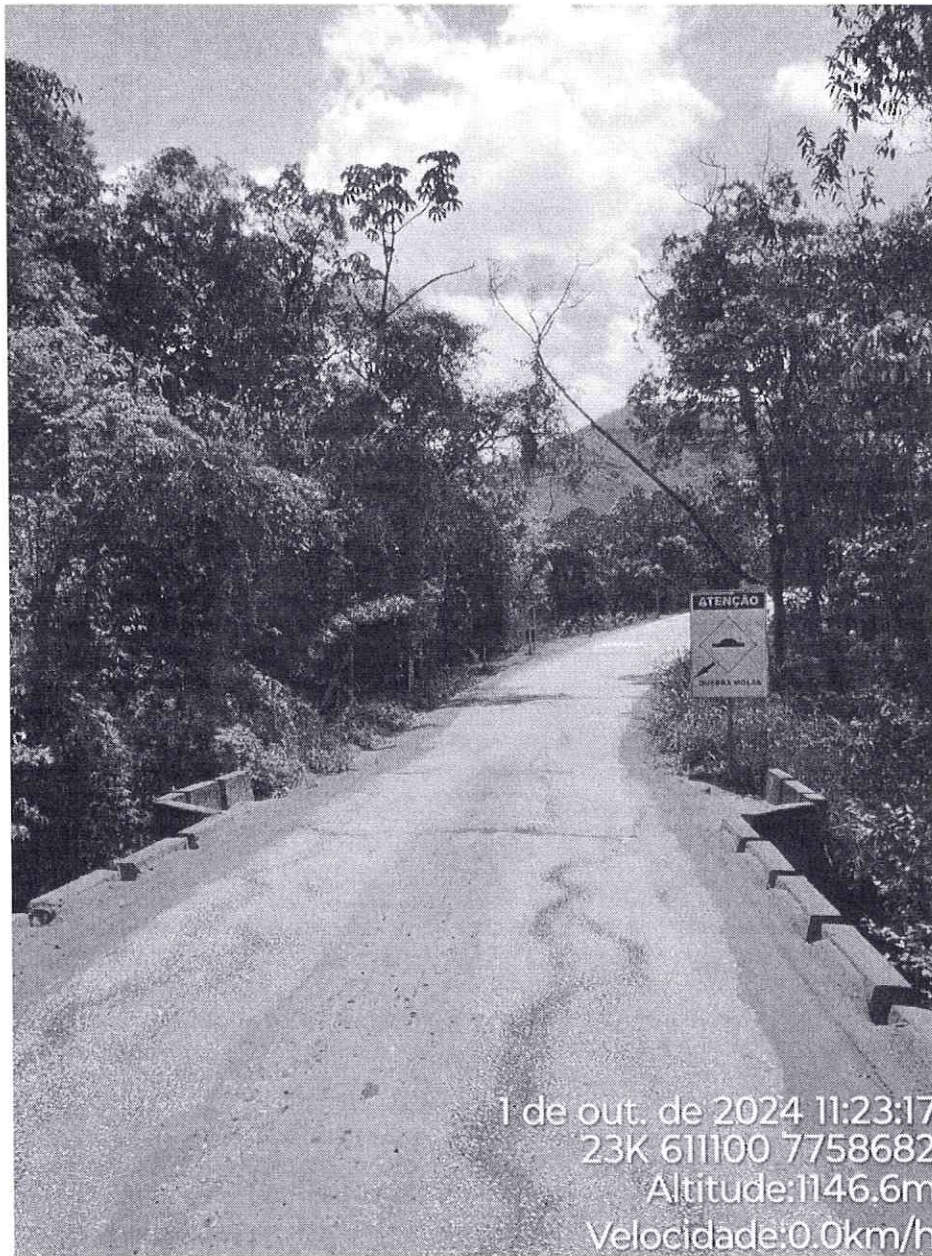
Vista da ponte. Fonte: SEMAM,2024.
